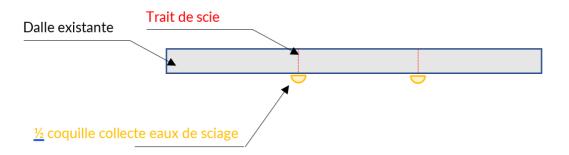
coupe transversale de la structure de protection phase travaux – Variante 2
